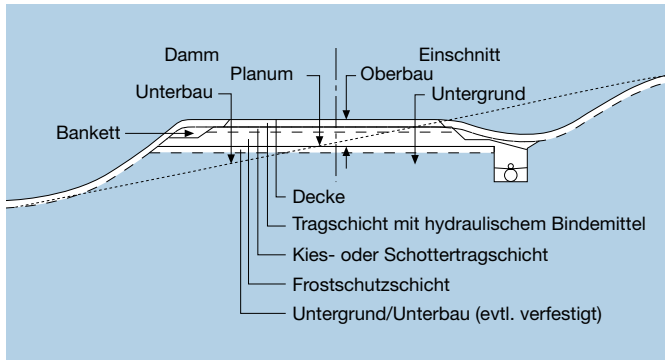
Beispielhafter Aufbau einer Befestigung mit Betondecke außerhalb geschlossener Ortslage im klassifizierten Straßenbau – Damm/ Einschnitt
